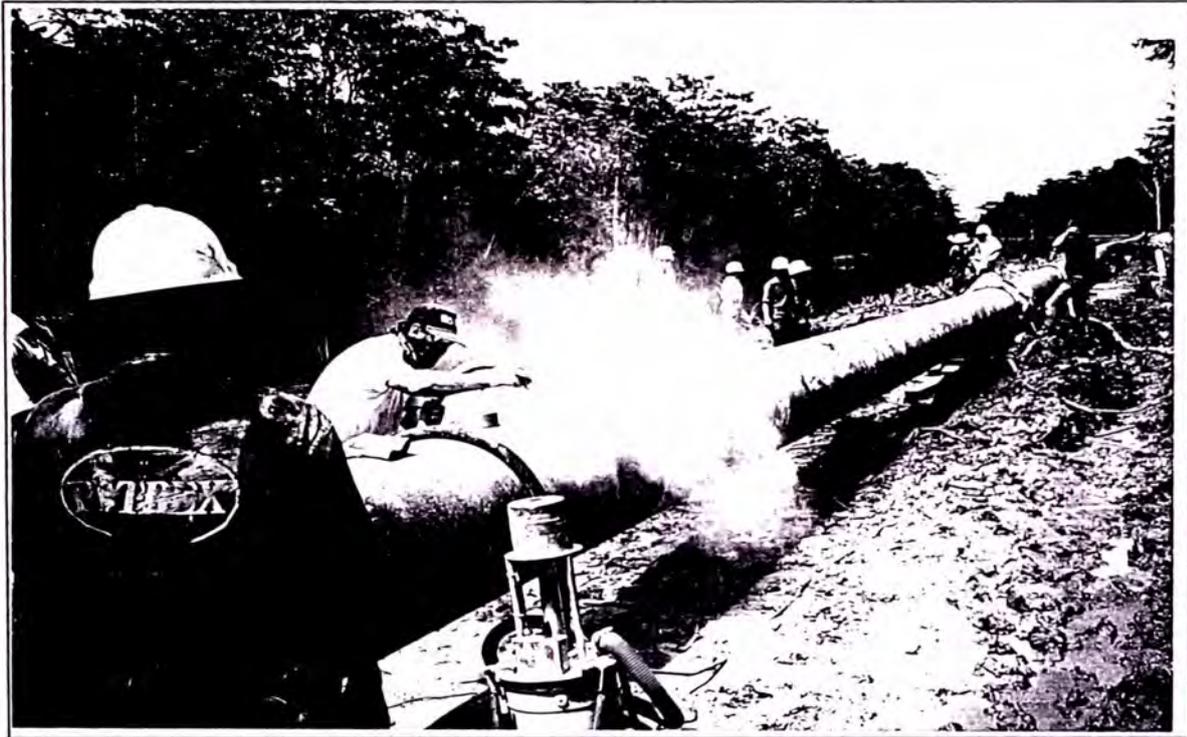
Aplicación de polvo epóxico y calentamiento de siguiente junta
